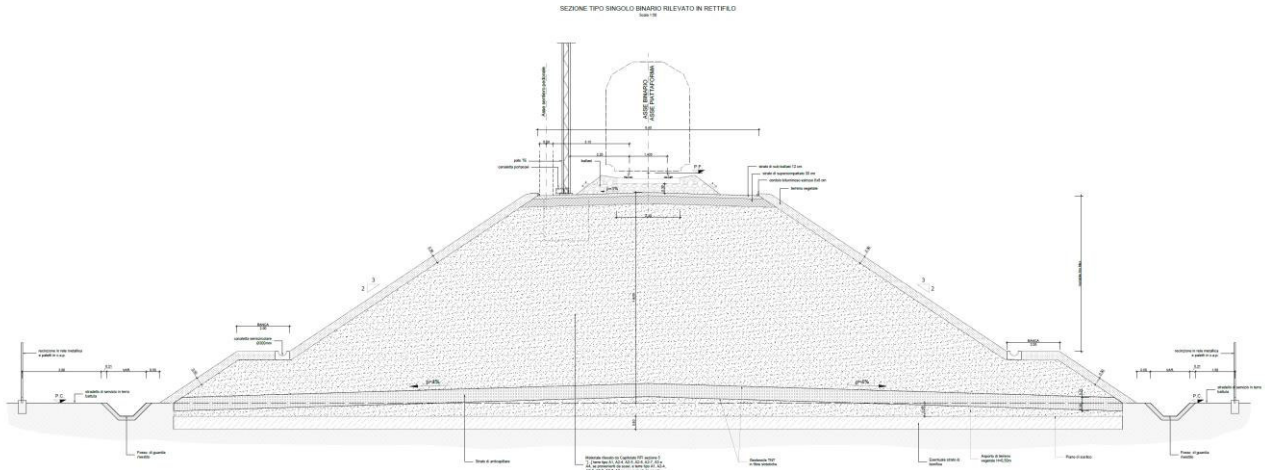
Sezione tipo rilevato, in rettilo con banche
